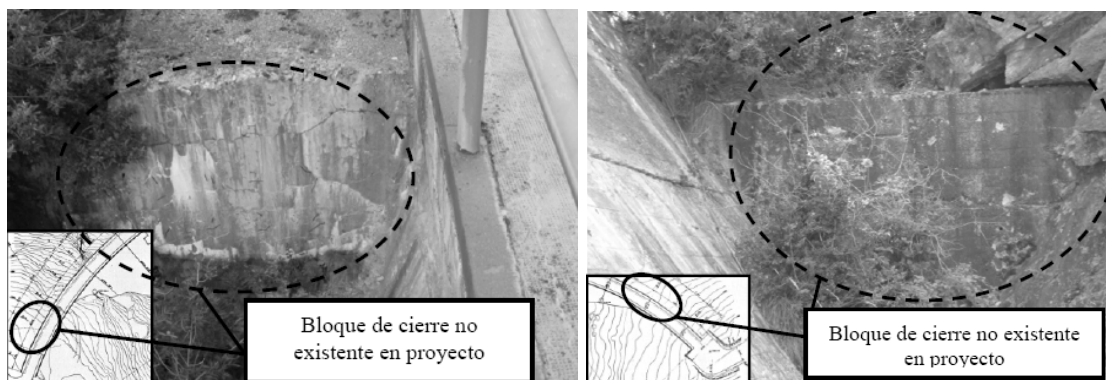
Bloques de cierre en los estribos – aguas abajo.
